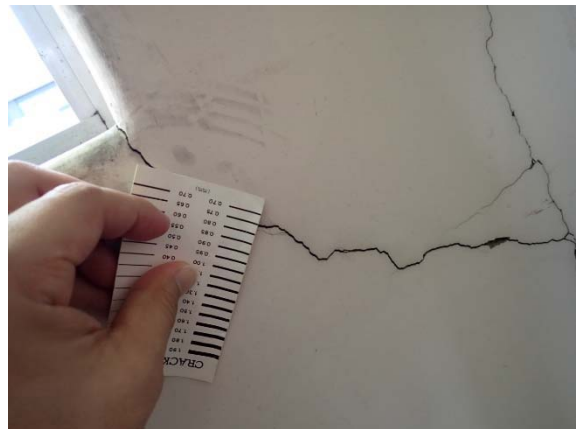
内壁ひび割れ（階段室部分）
